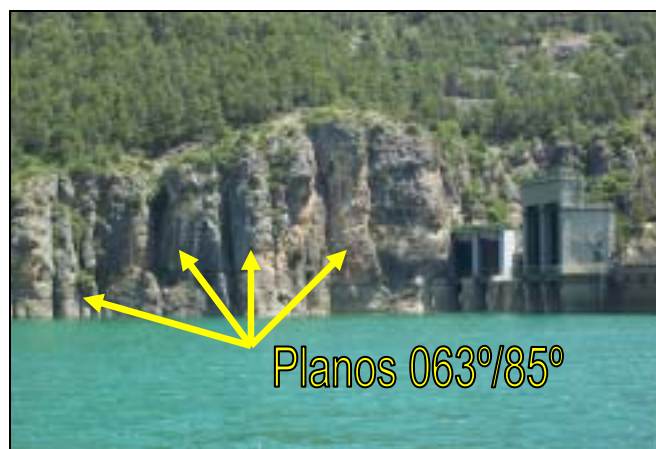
Foto del estribo izquierdo de la presa. Al lado del estribo se observan unas importantes fracturas casi verticales.
